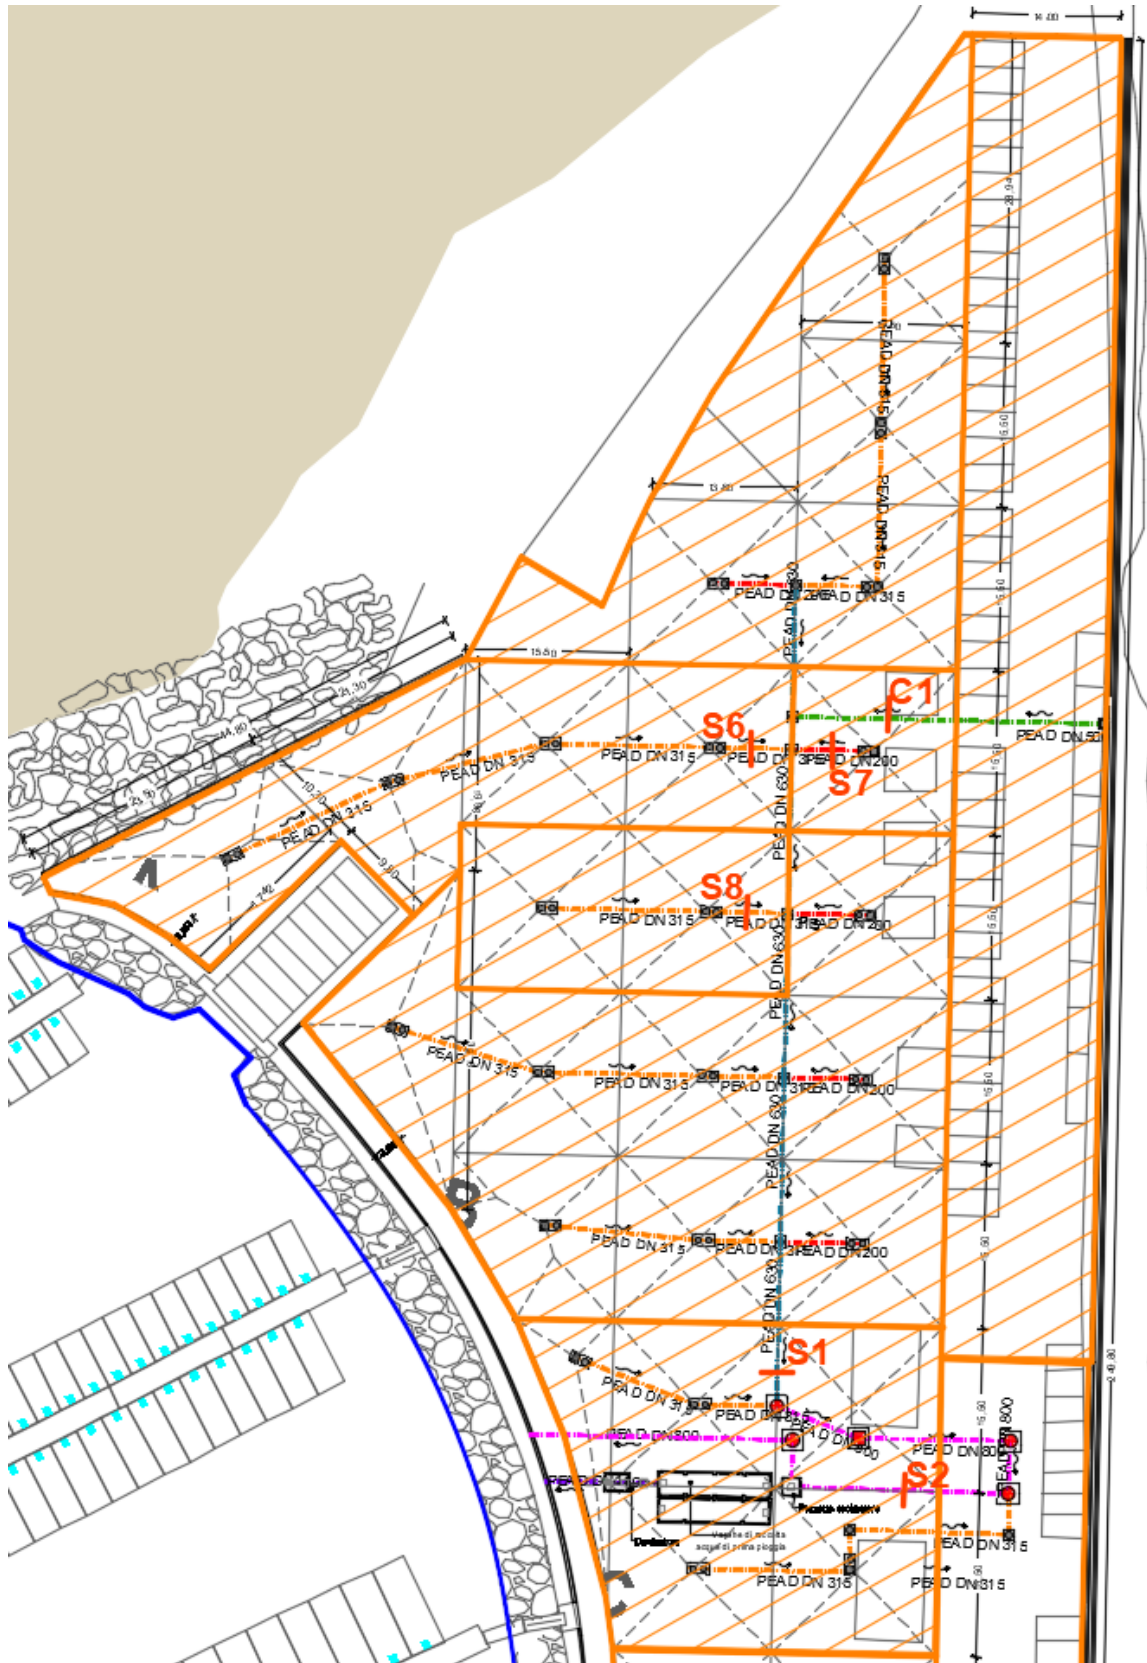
Planimetria con indicazione aree scolanti e sezioni di controllo impianto 1
